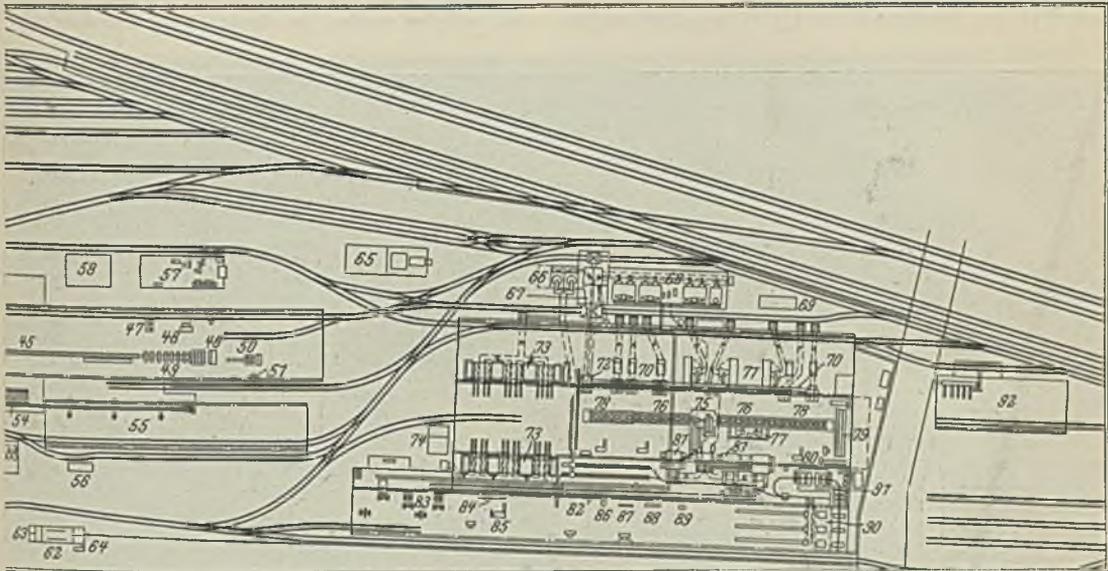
Grundriß der Anlagen der Portsmouth Steel Company, Portsmouth.
